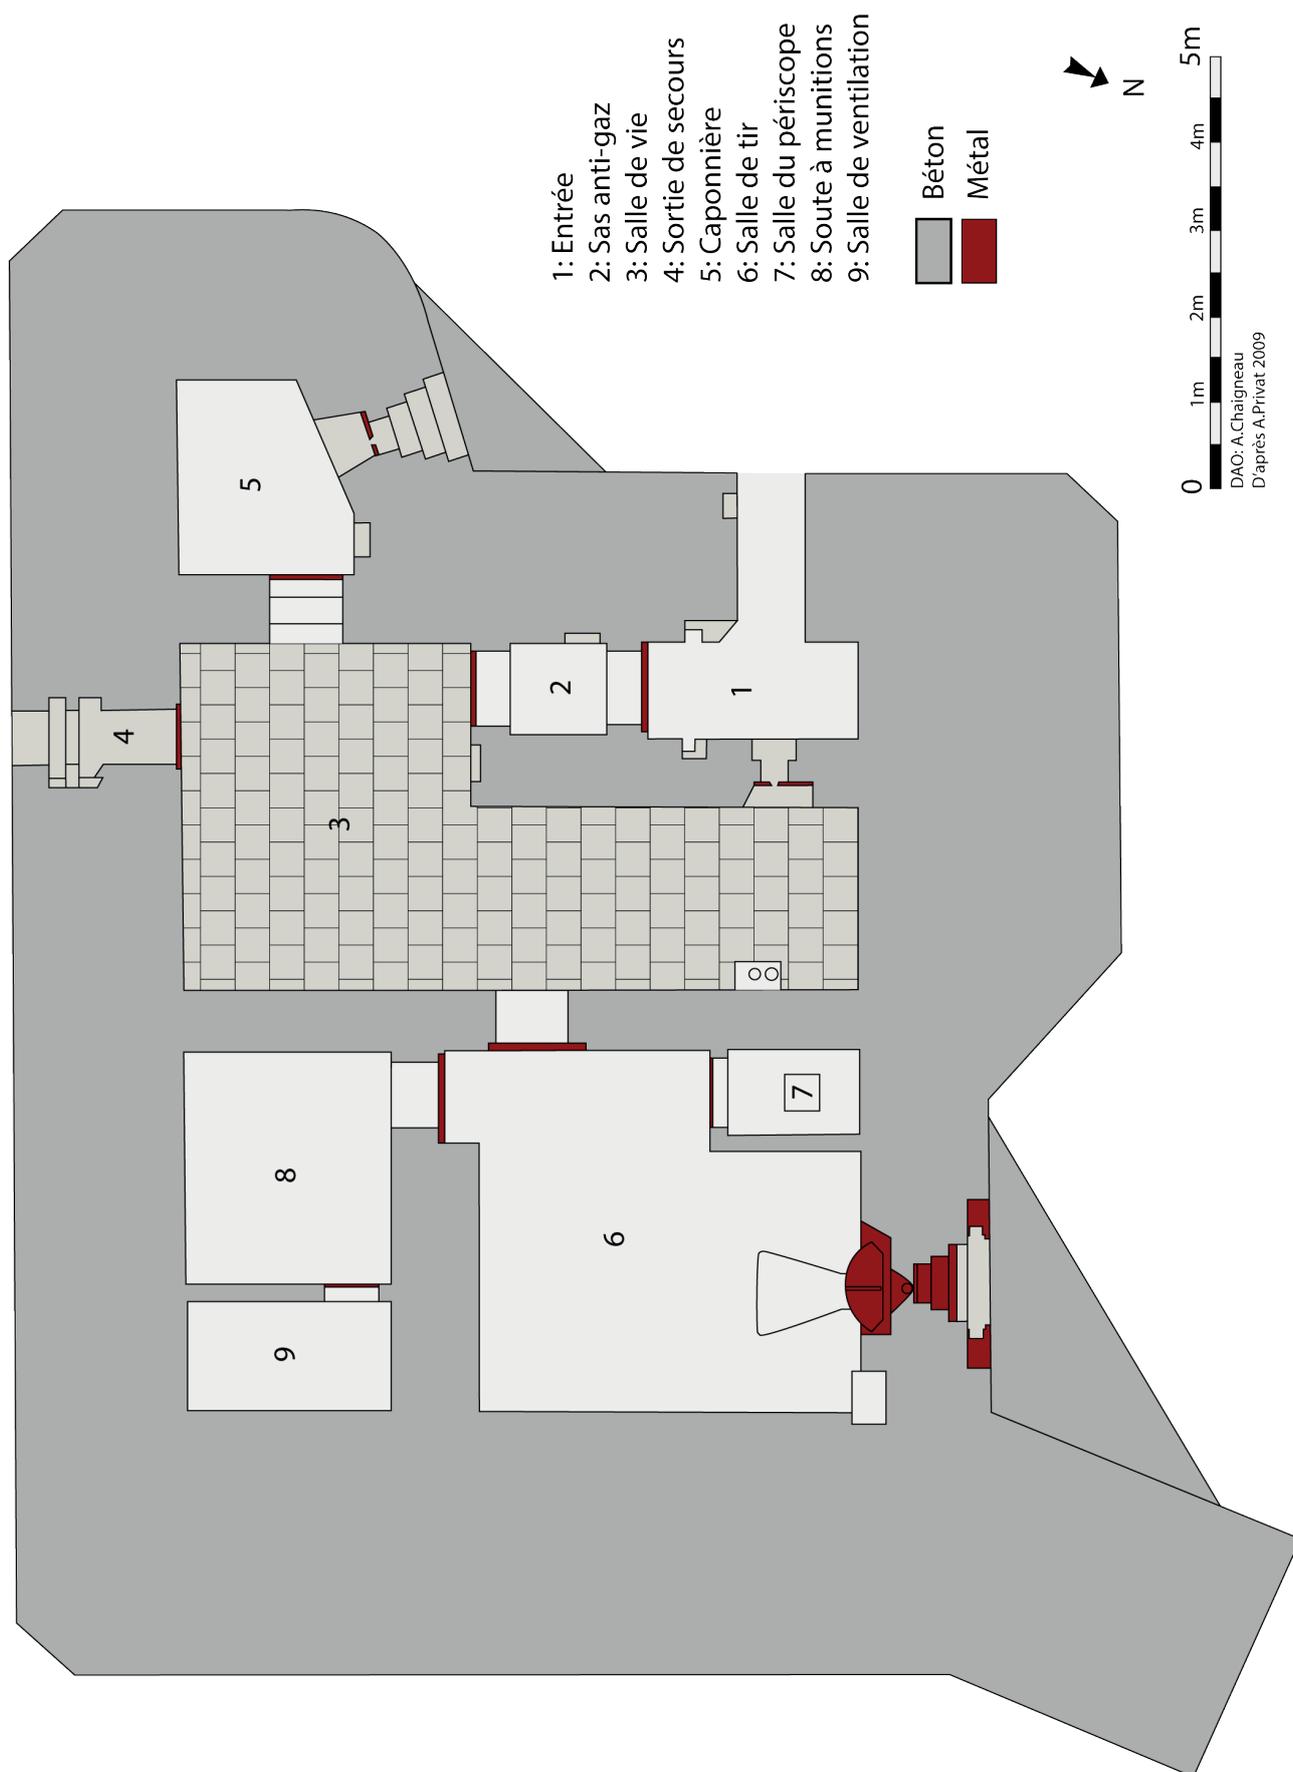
Plan du blockhaus 506d du Parc de la Chêneraie
